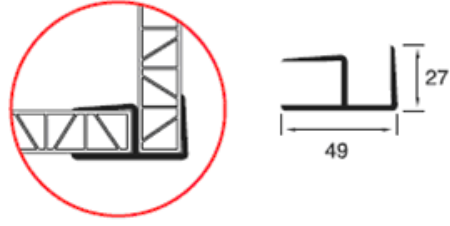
Pladeck 625mm*2500mm*18mm
